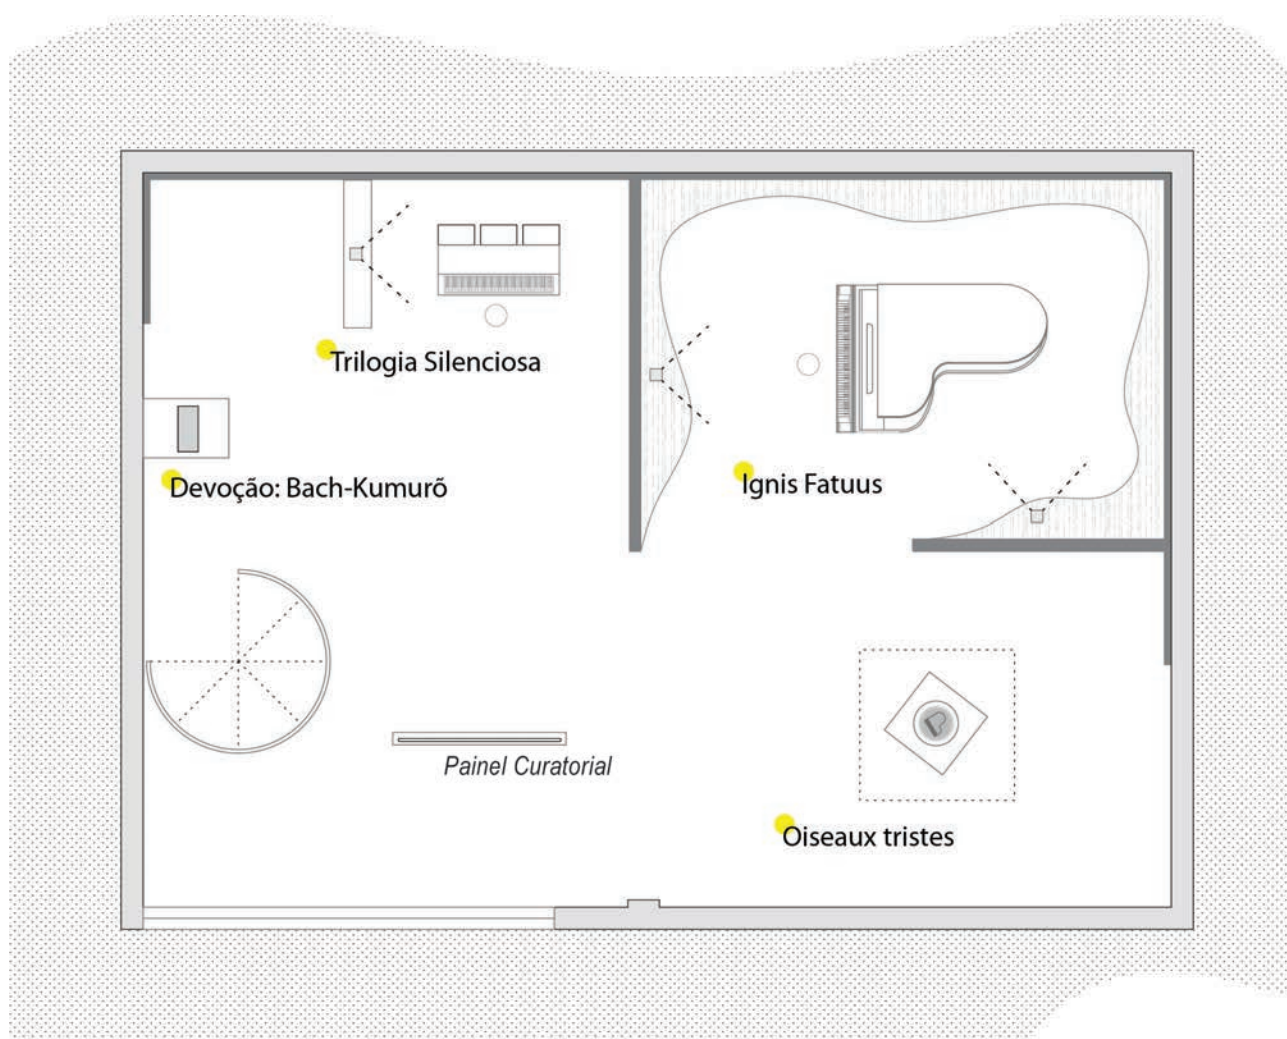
Planta da Galeria do Instituto de Artes da Unesp com a localização das instalações
